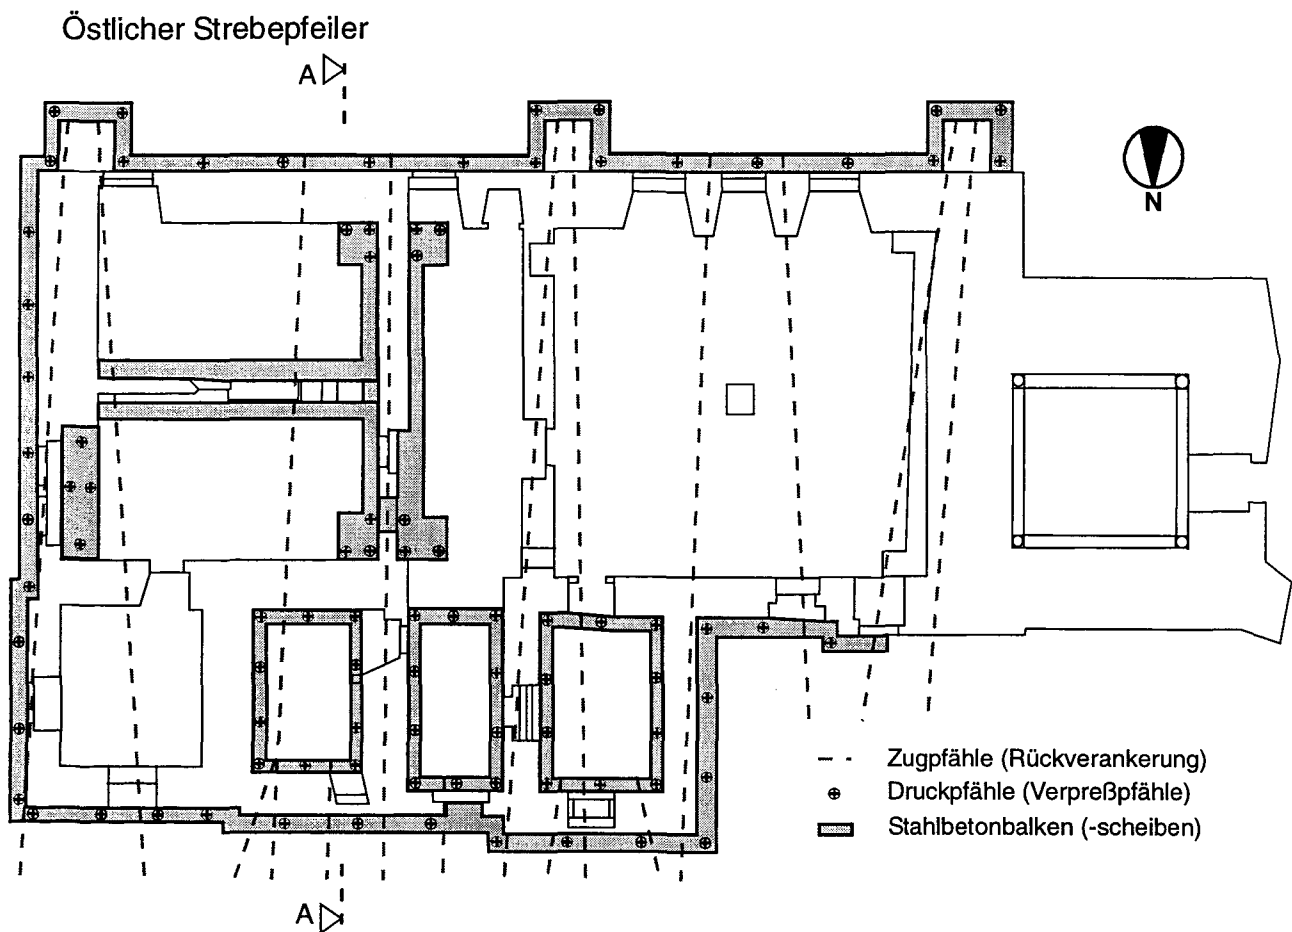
Sicherungskonzept der Burganlage [2], Darstellung im Erdgeschoßgrundriß
